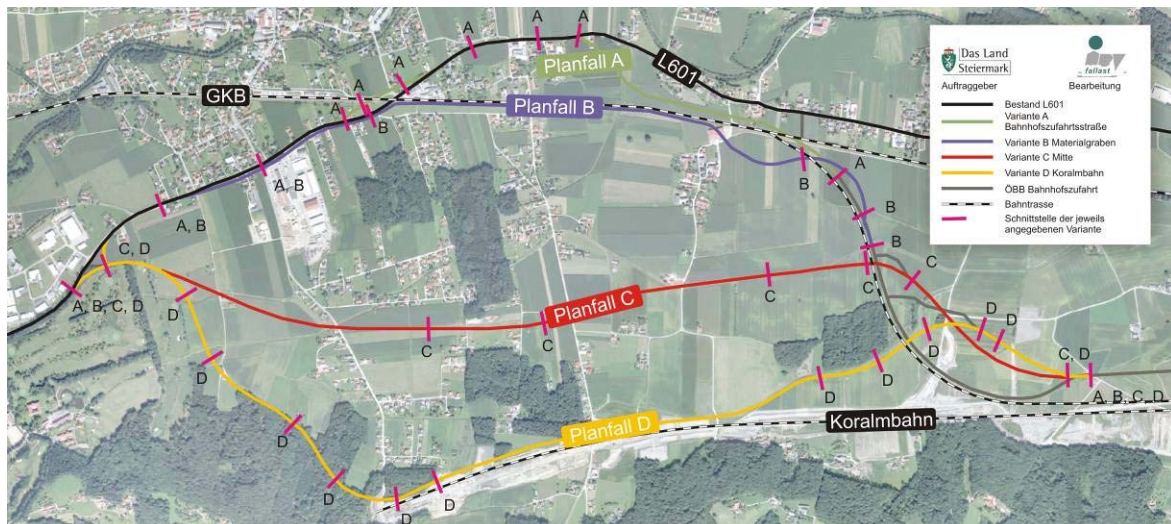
Übersicht Westvarianten Planfall B und Planfall D (Fallast et al. 2013)
